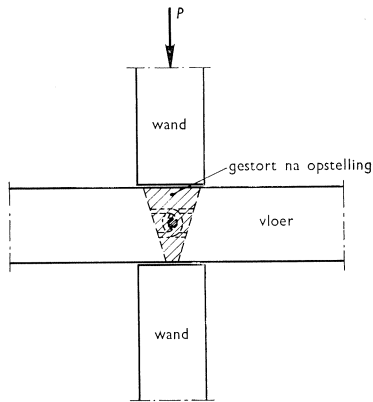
Schema van een aansluiting tussen wanden en vloeren. Aansluitingsvlak wand-vloer kan geen trekspanningen opnemen.
